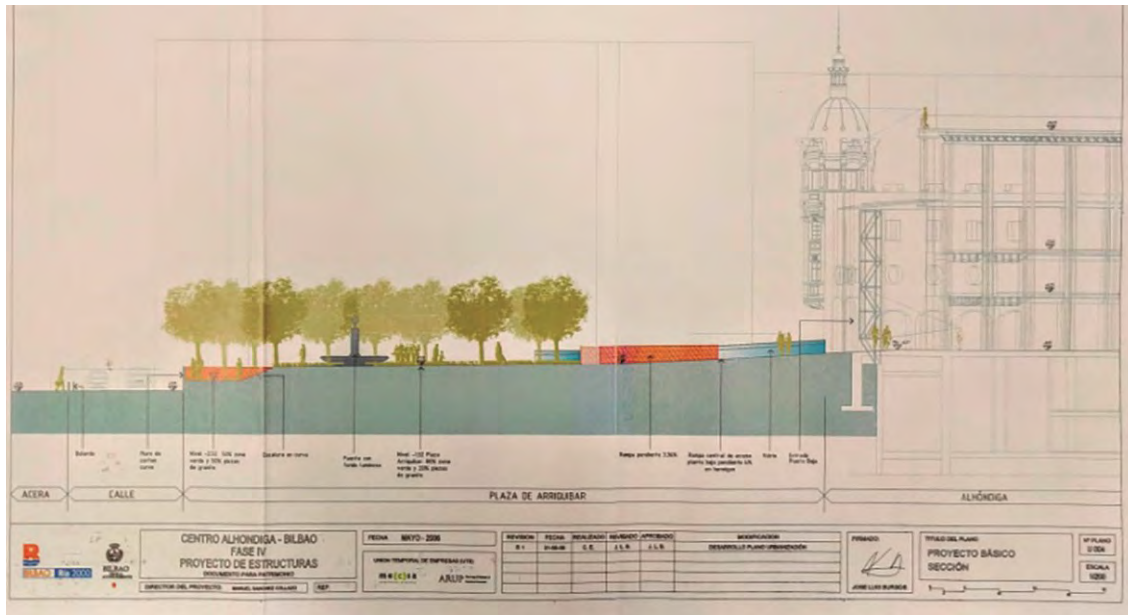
Plano básico de sección en el que se puede apreciar la anexión de la plaza y el impacto sobre la fachada de Arriquirar.
